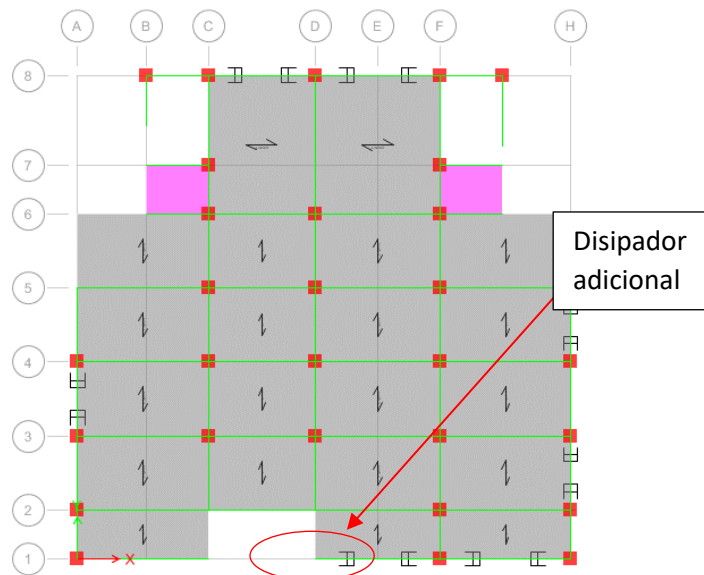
Vista en planta, cuarto caso de ubicación de dispositivos
